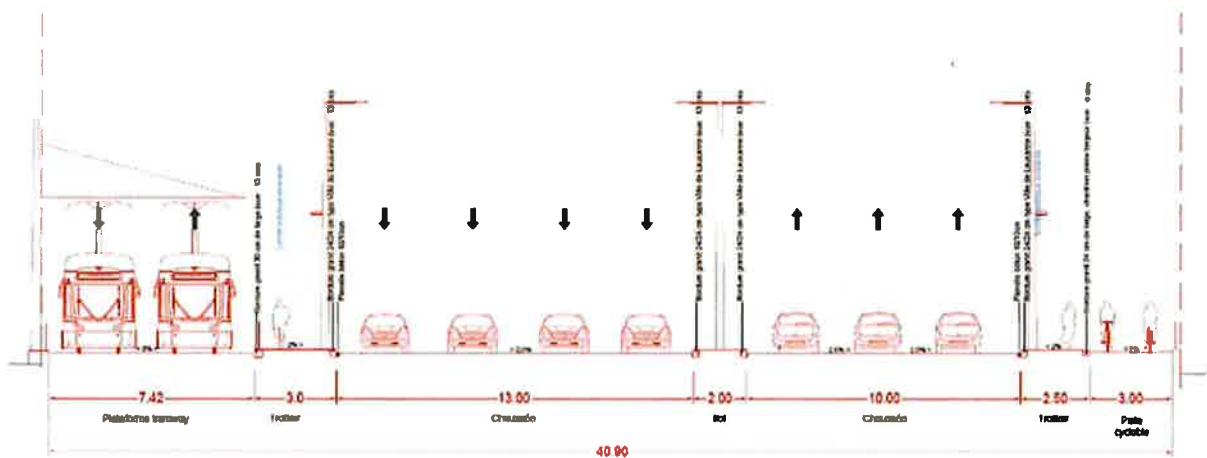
Coupe de principe dans le carrefour de la Croix-de-Plan
